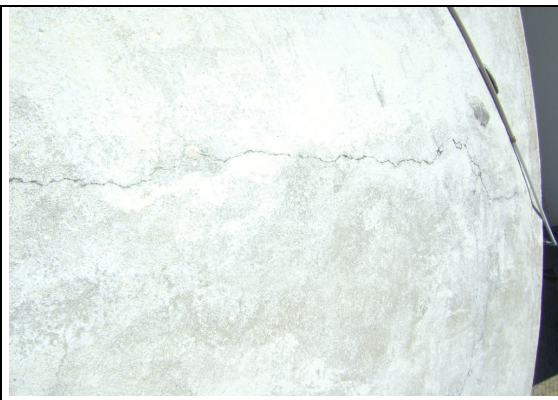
RAP-02: trincadura na laje de cobertura.
